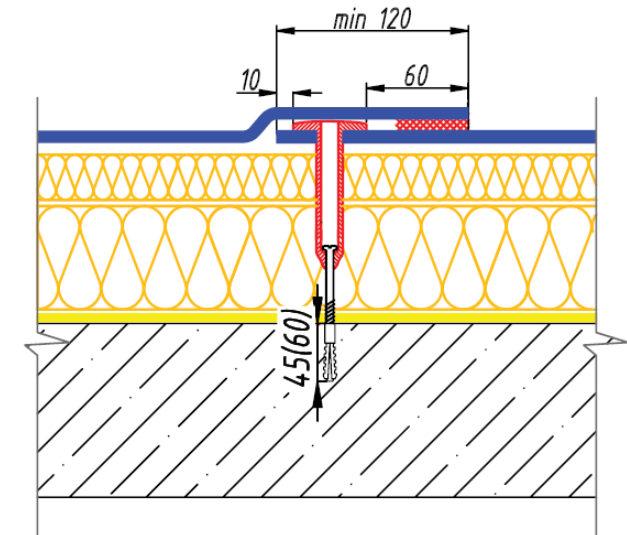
Схема крепления крепежа в железобетонное основание
